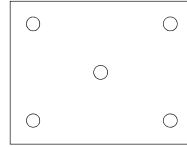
Panneaux ISOVER TF de dimensions 1200 × 600 mm - plans de chevillage en plein
